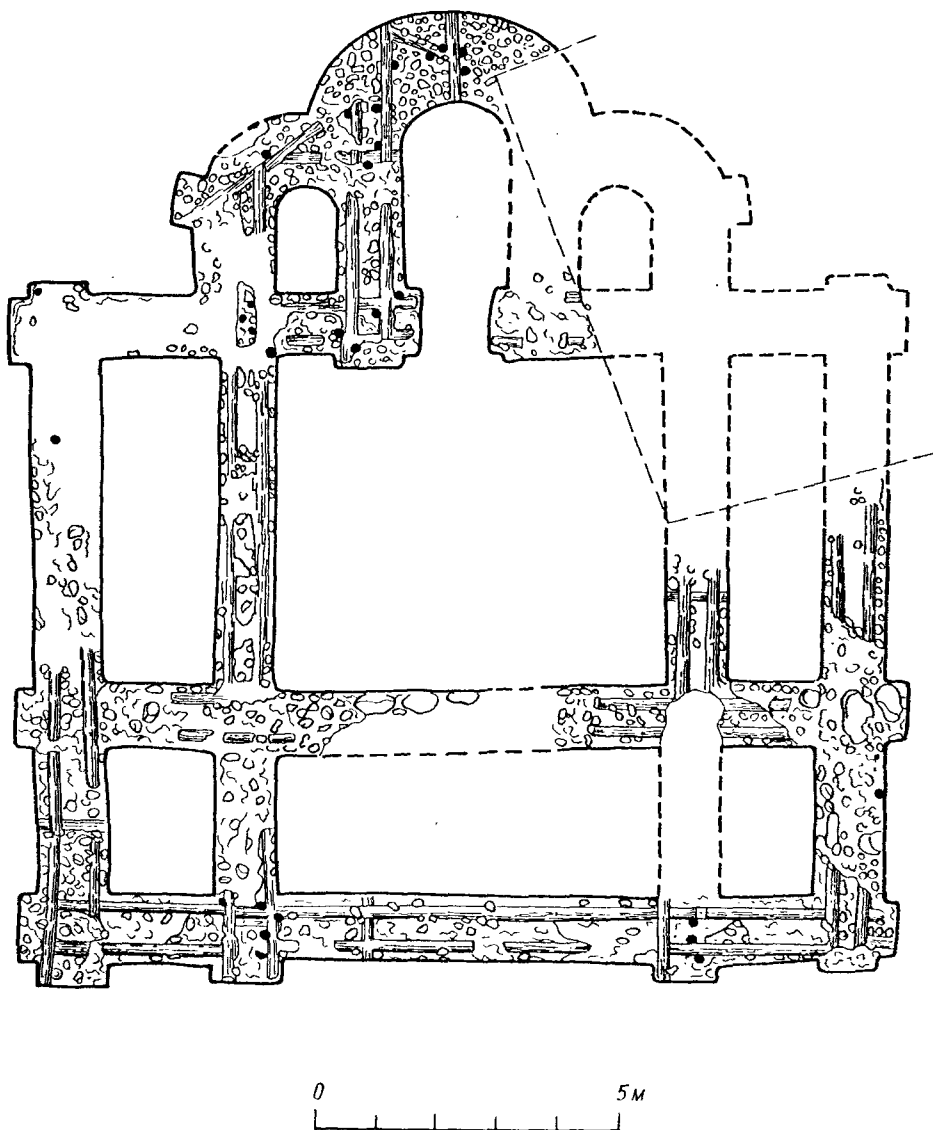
Церковь Андрея в Переяславле. План раскопанных фундаментов.
